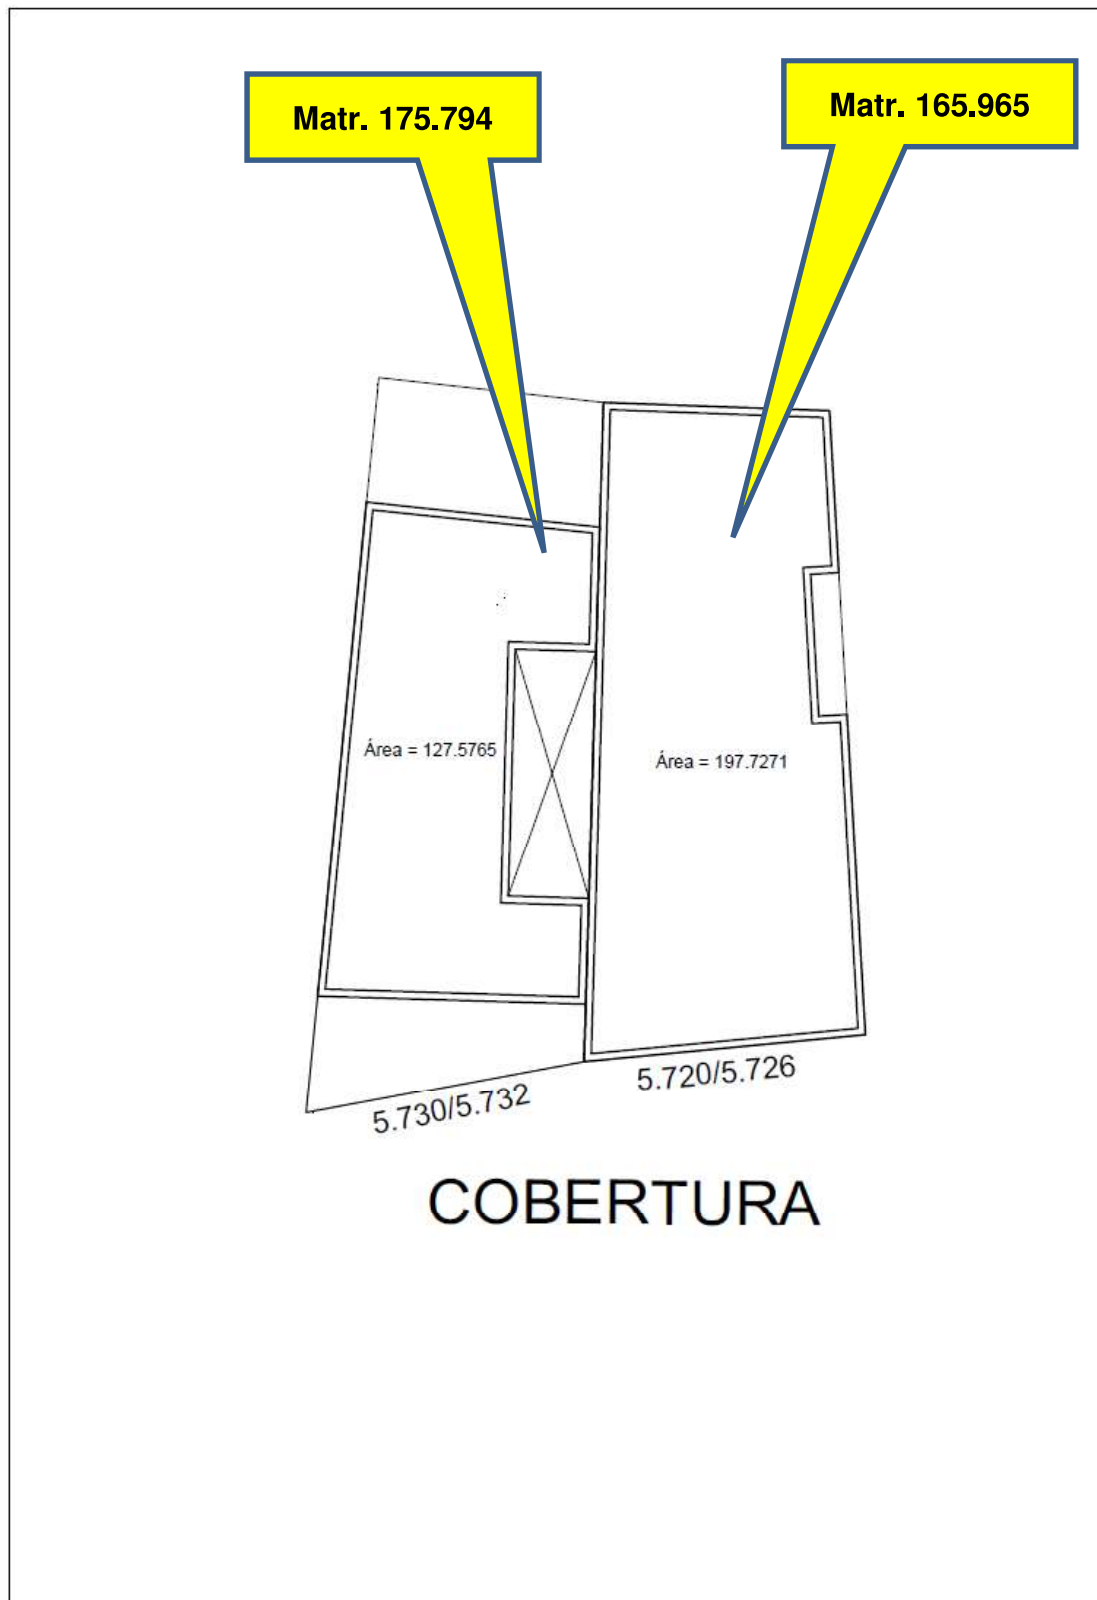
Croquis do pavimento de cobertura dos Imóveis sob Matrículas nºs 175.794 e 165.965 – 14º CRI.
